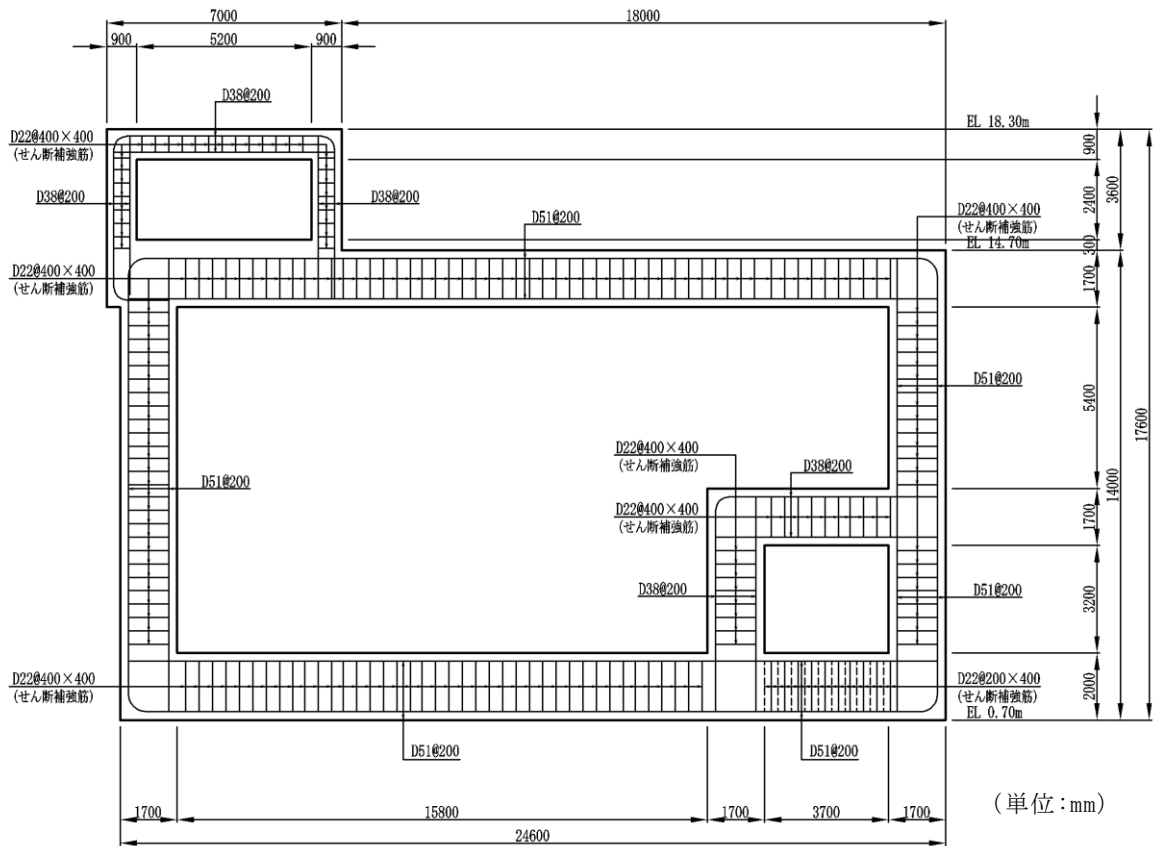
第 1 ベントフィルタ格納槽概略配筋図 (C-C 断面)
